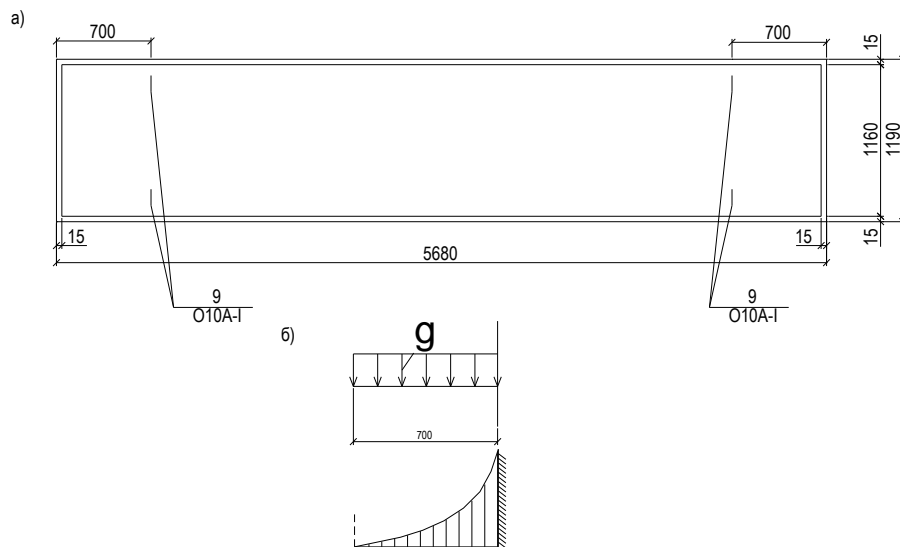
До розрахунку панелі перекриття на монтажні навантаження
